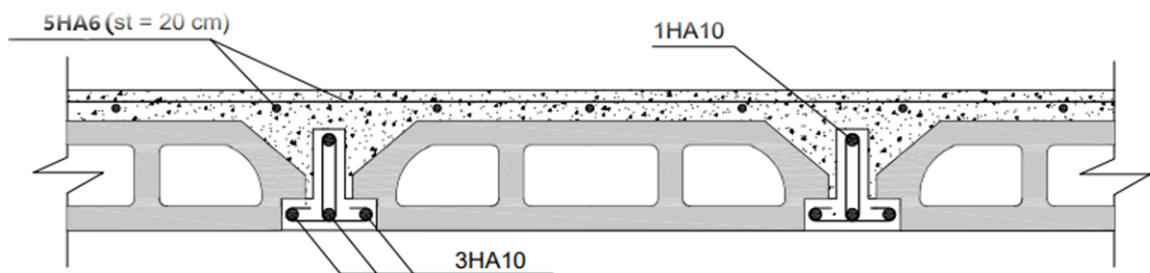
Schéma de ferrailage de la dalle à corps creux
